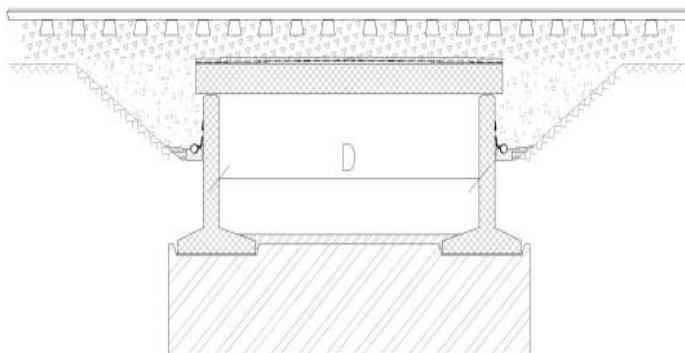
Exemplu de podeț realizat din dale prefabricate din beton armat
